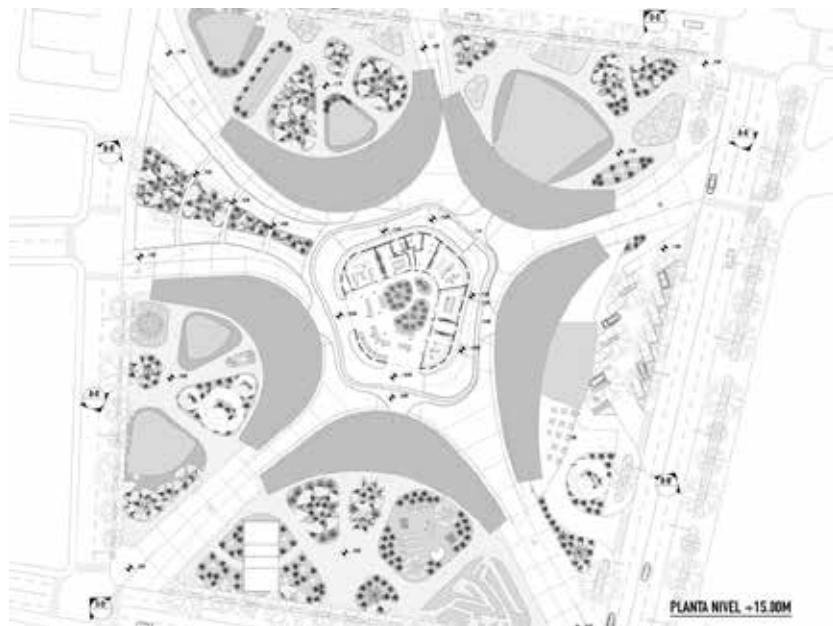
Planta 3 Nivel +15.00. Fuente Propia. 2017.
